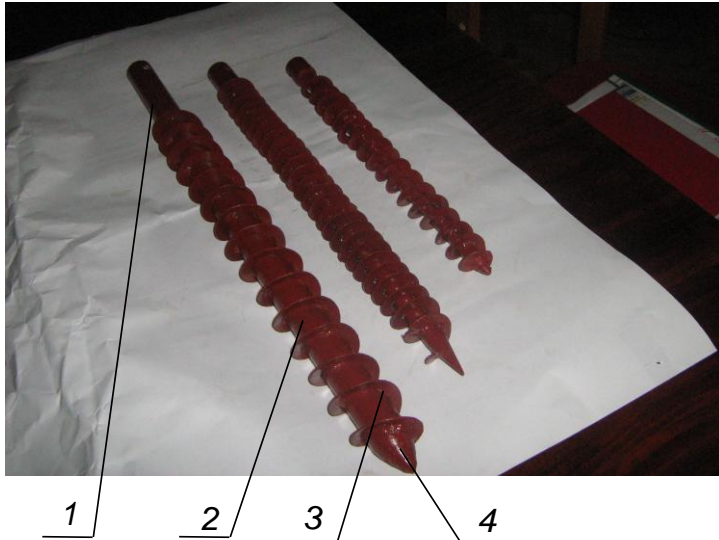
Експериментальні зразки гвинтових опор різних типорозмірів: 1 – корпус опори; 2 – циліндричний стержень; 3 – гвинтова спіраль шнека; 4 – конічна насадка
